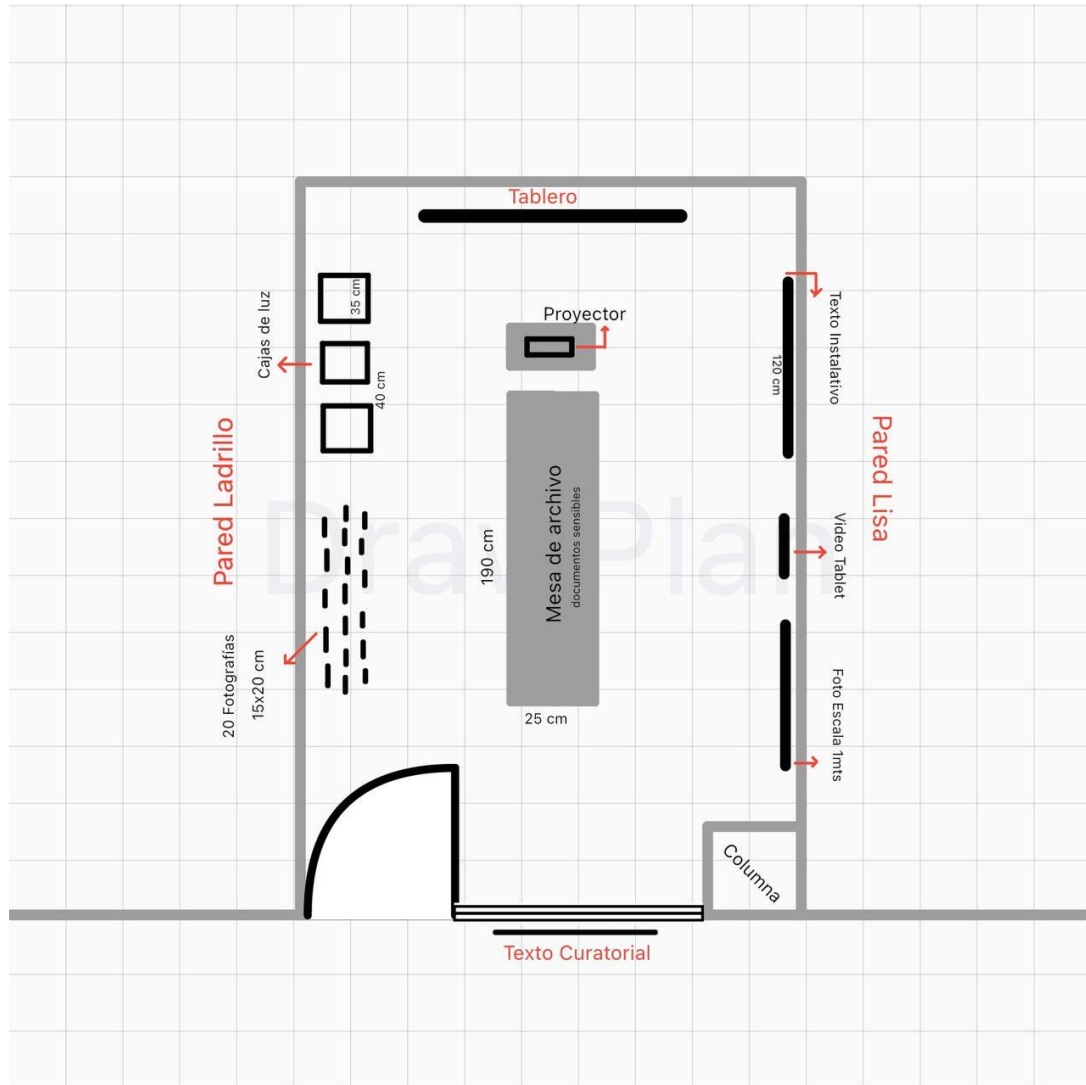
Plano de montaje: Sala de tutorías LAV, II planta (2022). Elaboración propia.
